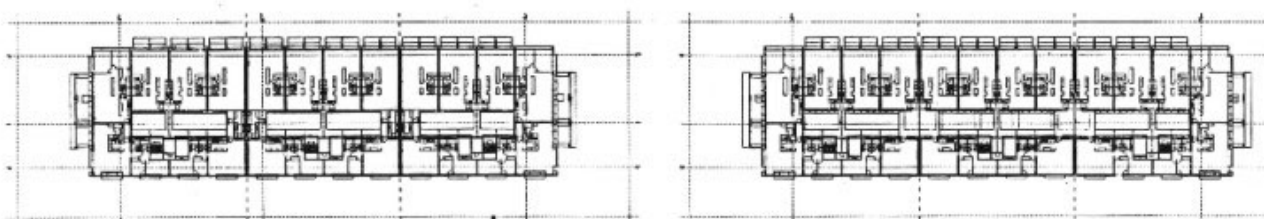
planta 2º e 3º pavimento do Galpão 8. Fonte: Revista Arquis nº 1.
